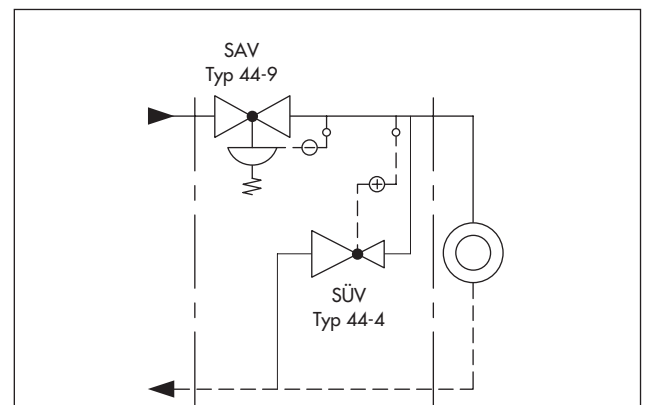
· Absicherung einer Hausstation mit SAV und SÜV
